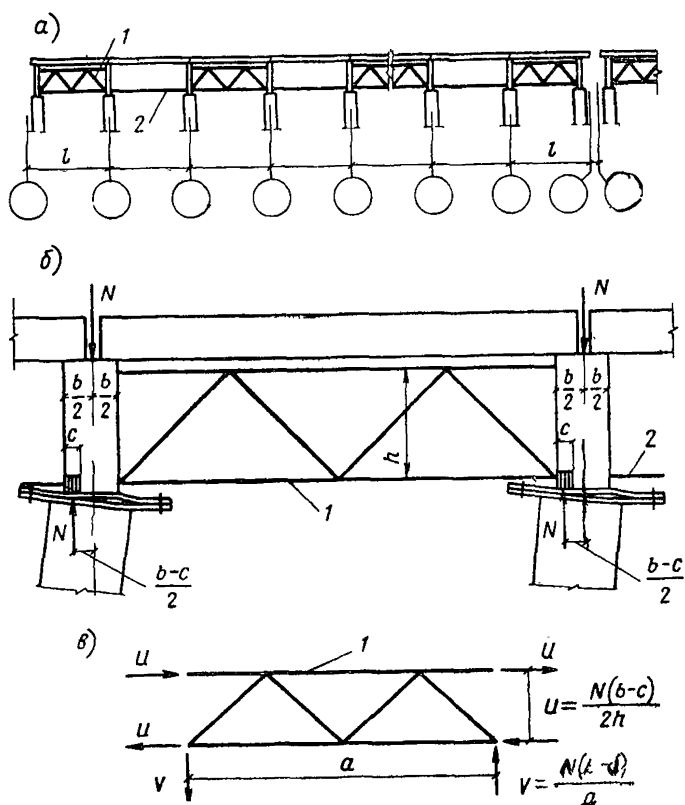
Схемы к расчету вертикальных связей между опорными участками стропильных конструкций на усилия от смещения места приложения вертикальной нагрузки на колонну
